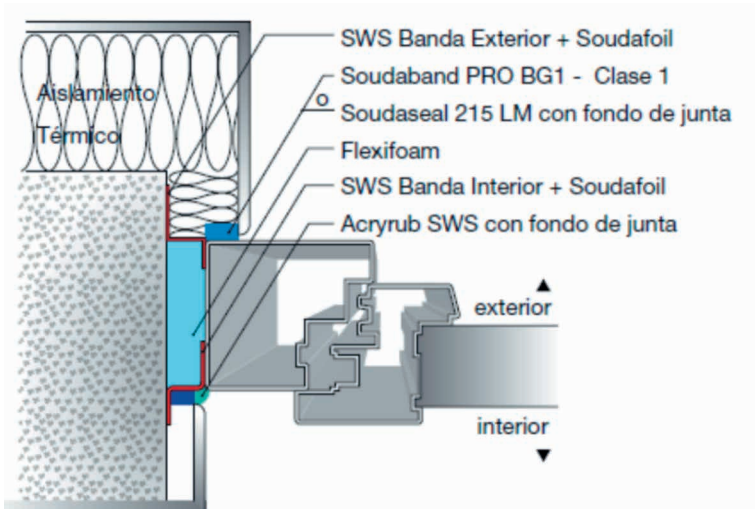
Instalación en Túnel o a testa sobre muro con sistema SATE o ETICS.
